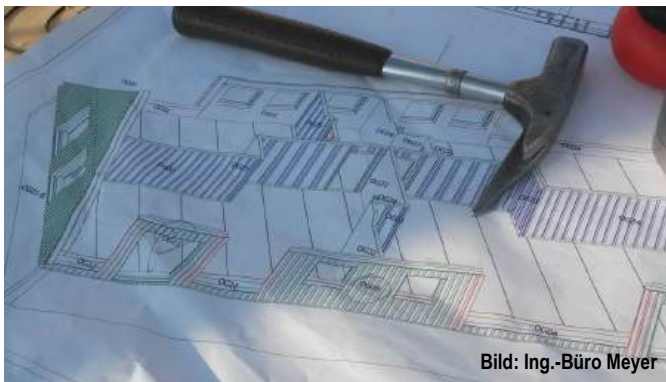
Das Zimmererhandwerk arbeitet heute in weiten Teilen mit moderner CAD-Technik. Die geometrische und konstruktive Simulation erfasst alle Details des Rohbaus. Im Bild ein Montageplan mit Nummerierung der Elemente.
